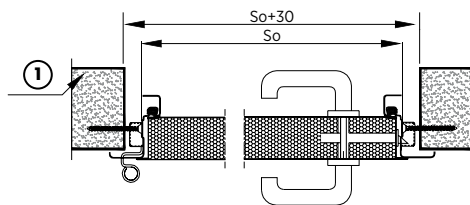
Pose à la construction en acier – bloc-porte à un vantail, bâti angulaire sans rupture de pont thermique – coupe horizontale
